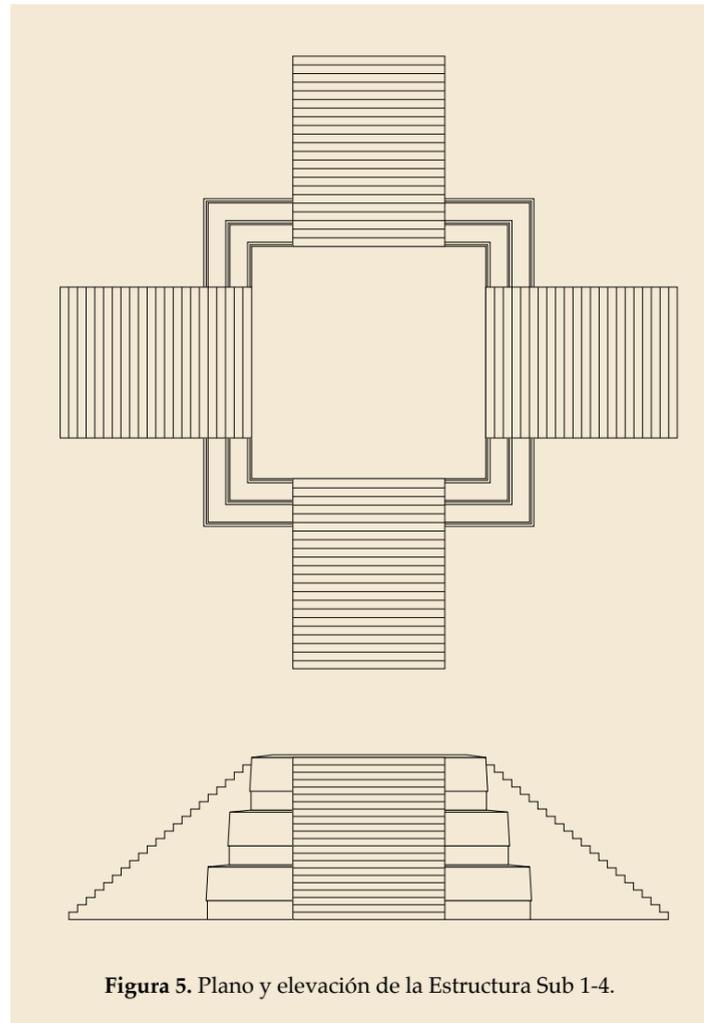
Plano y elevación de la Estructura Sub 1-4.
